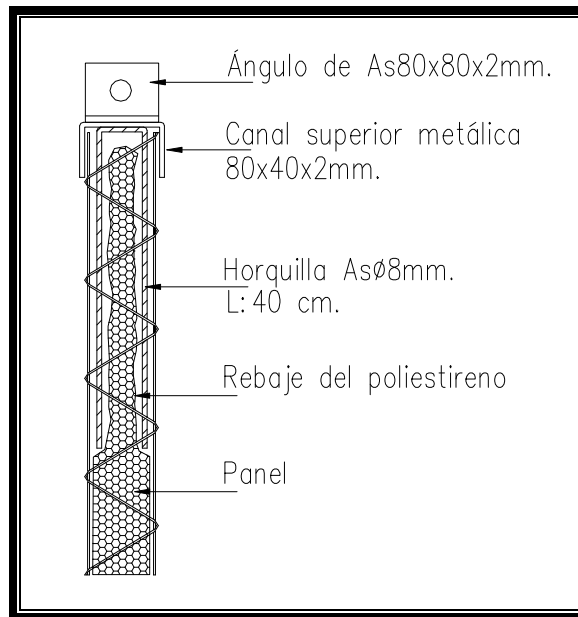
Detalle de fijación de accesorio para unir la techumbre (vista lateral)
